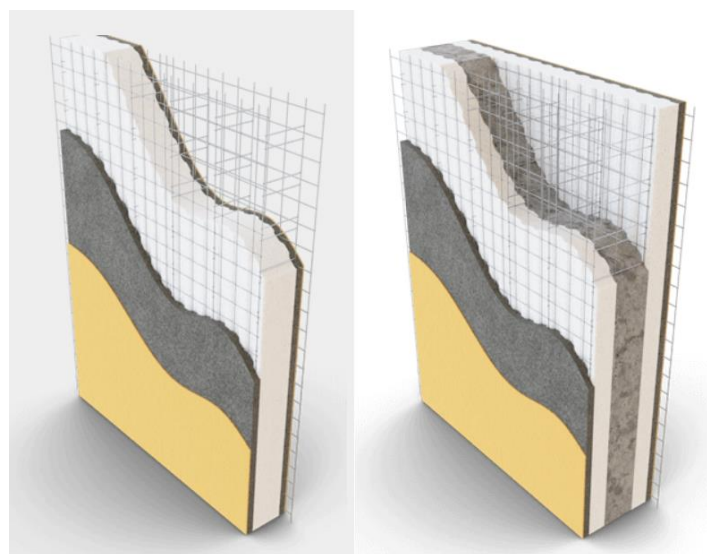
Discretización de muro simple y muro doble, Emmedue.
